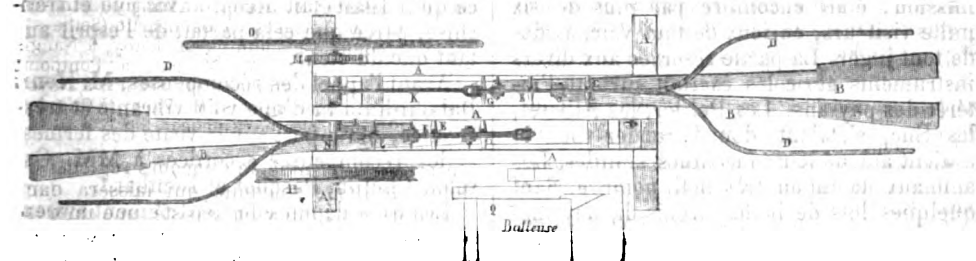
Plan de l'appareil barotrope de M. Pigneret.
